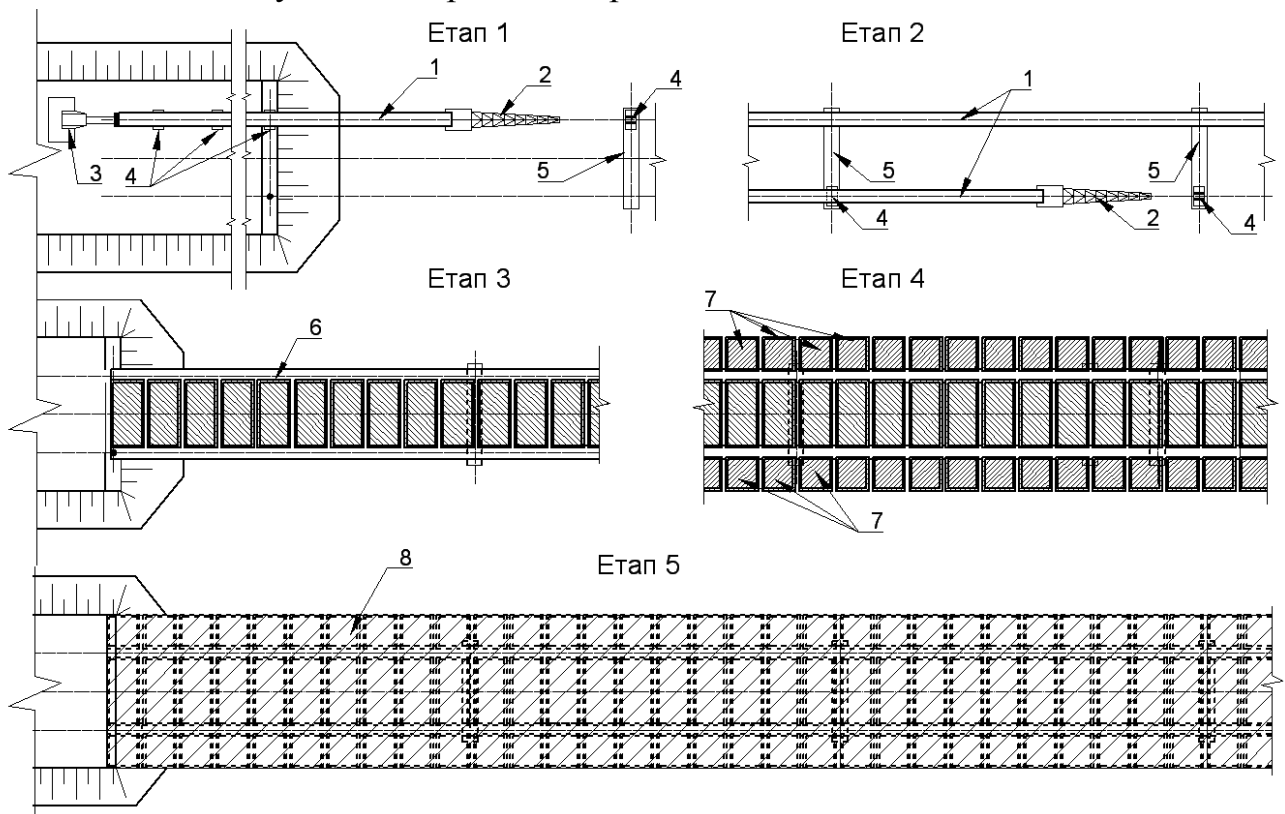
Етапи монтажу двобалкової нерозрізної збірно-монолітної залізобетонної прогонової будови моста методом поздовжнього насування: 1 – головна збірно-монолітна (збірна) балка, 2 – аванбек, 3 – обладнання для насування, 4 – шарнірні катки, 5 – ригелі опор, 6,7 – збірні прогонові і консольні ребристі плити, 8 – монолітна плита проїзної частини.
